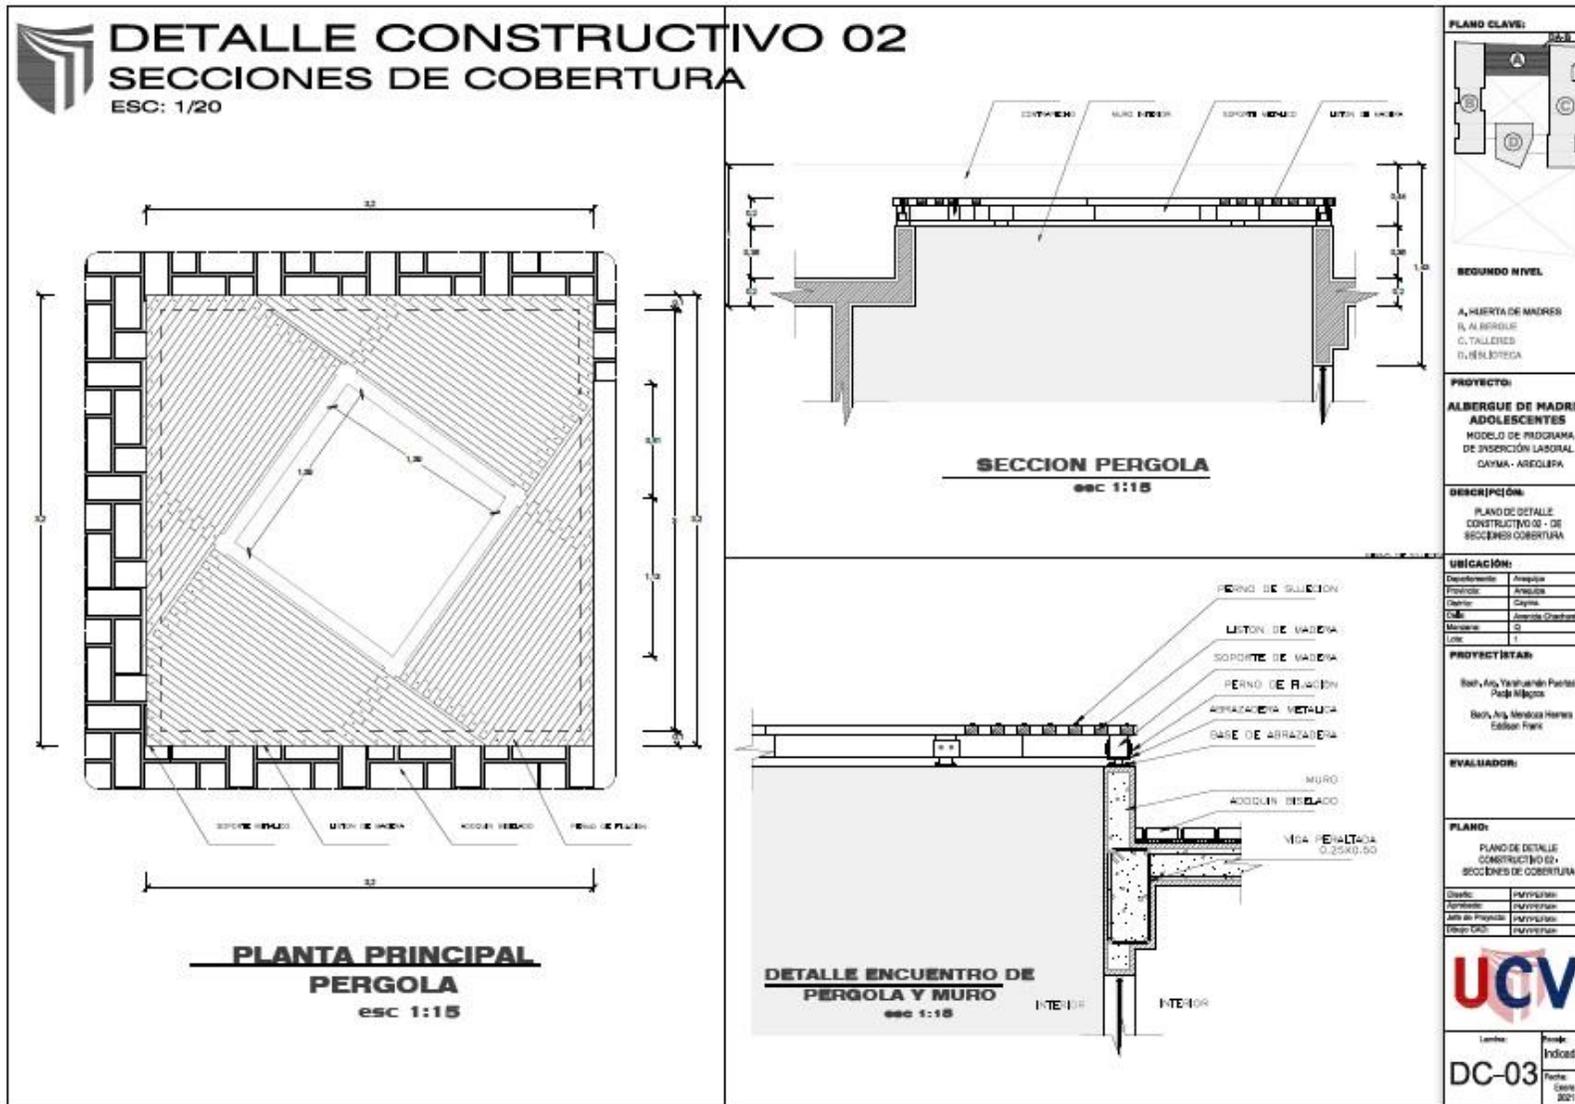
Detalle Constructivo 02 – Cobertura de zona Exterior de Aula en Cuna Jardín DC-03.
